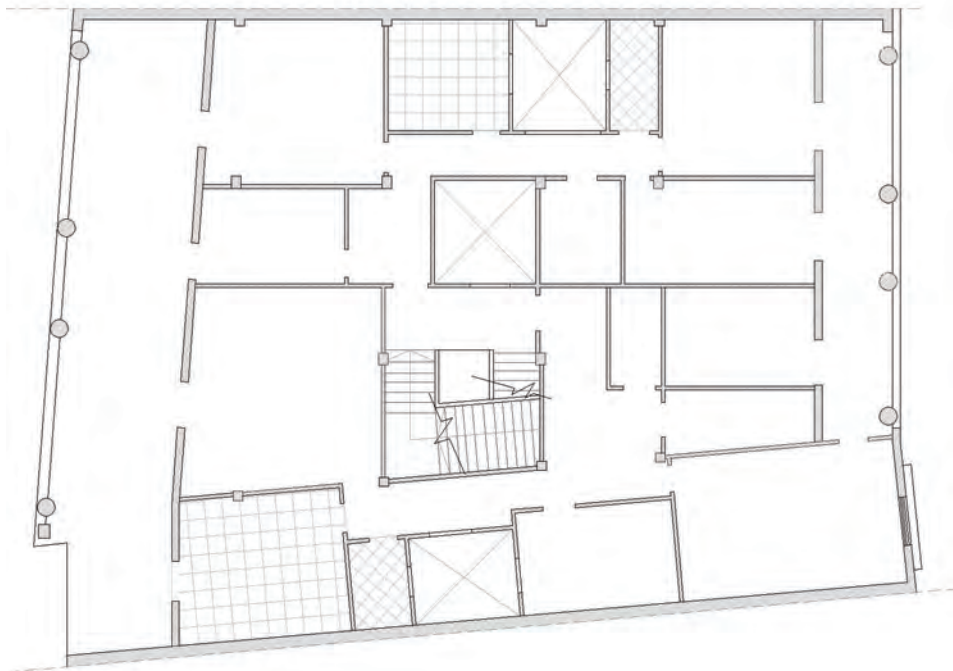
13. PLANTA BAJOCUBIERTA
